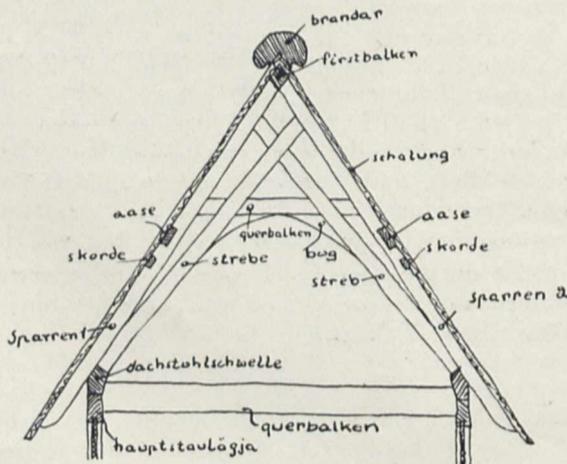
Querschnitt durch den Dachstuhl einer Stabkirche
